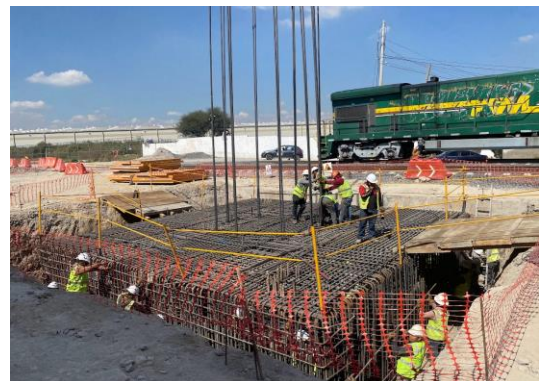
y 189 Autoría Propia (2023) "Vista externa de los trabajos de armado de acero en zapata y varilla longitudinal para el armado de columna"
